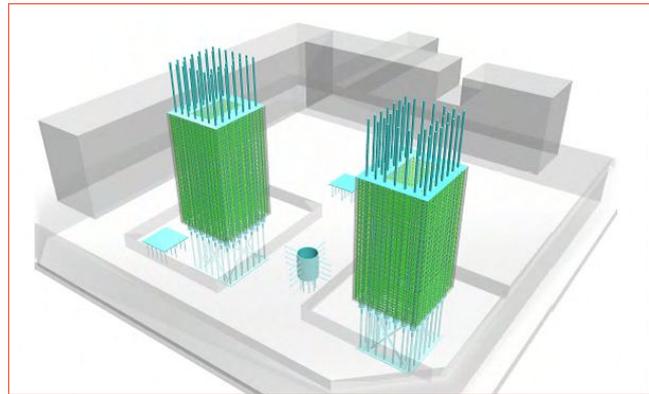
Render 3D delle strutture in cemento armato (pilastri, muro di reazione, fondazione)
